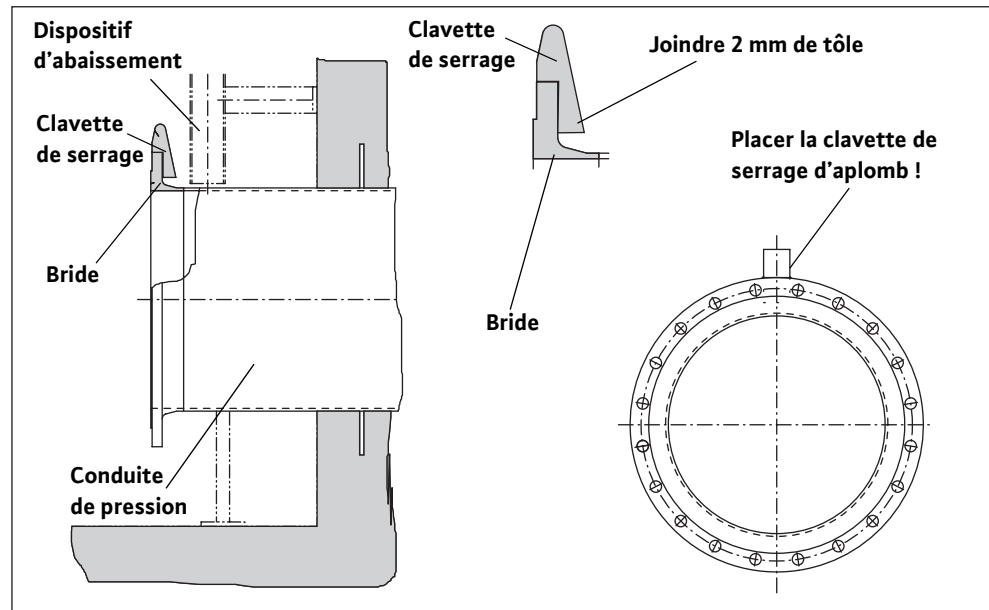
Montage sur la conduite de pression avec bride à souder à collerette
